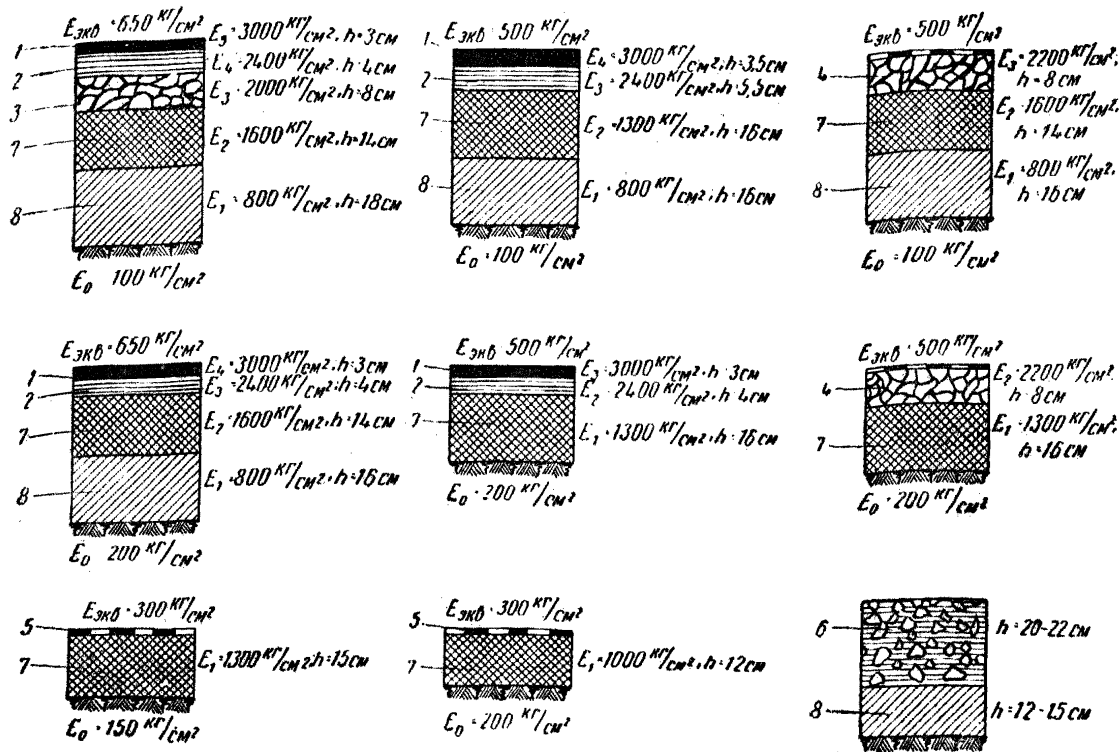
Примерные схемы конструкций дорожных одежд с цементно-грунтовыми основаниями
